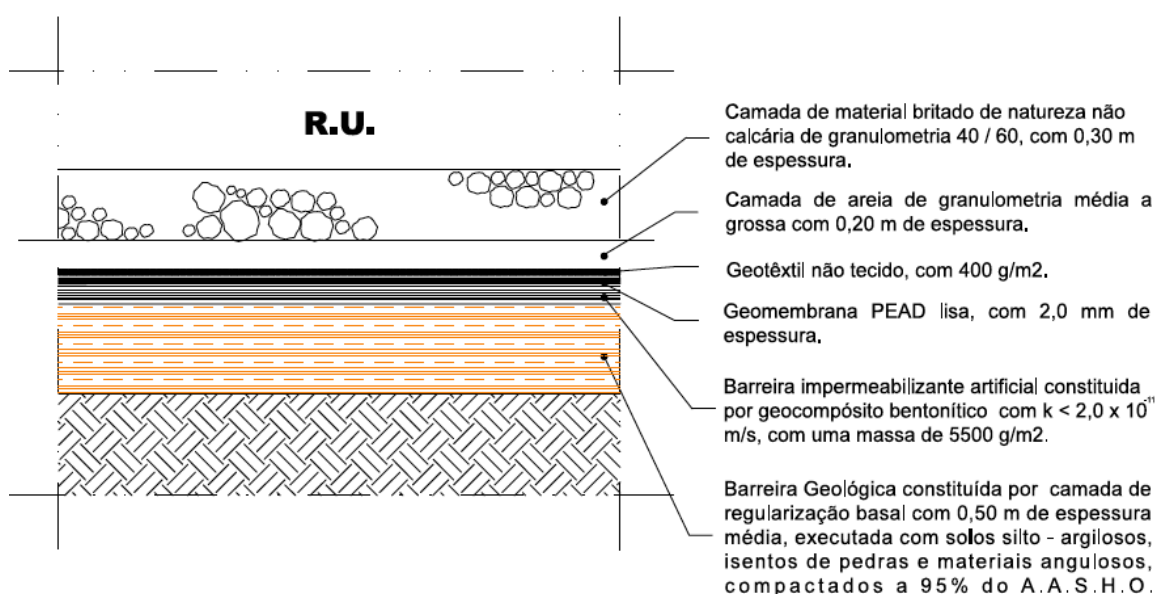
Pormenor do sistema de impermeabilização da zona basal
